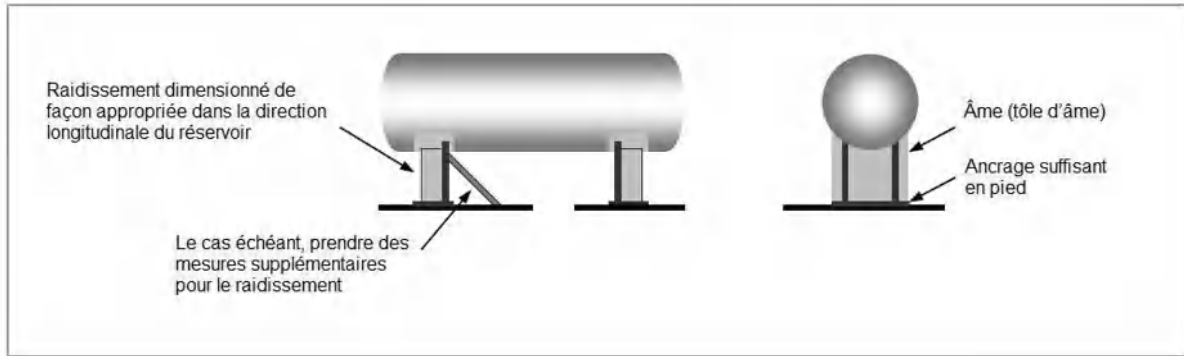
Réservoir horizontal : raidissement de la structure support dans les directions longitudinale et transversale [R26]
